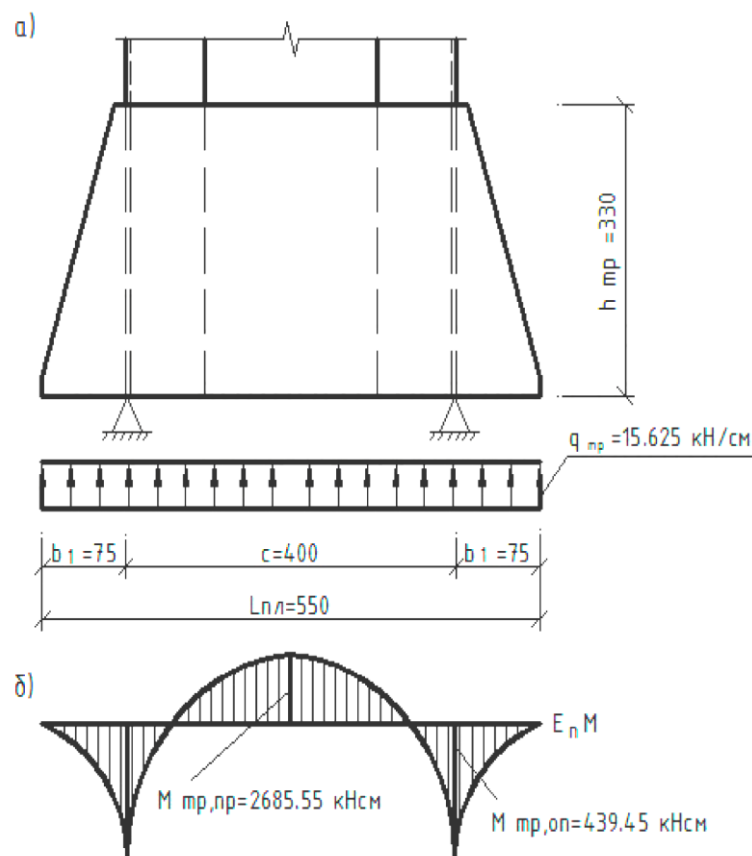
Розрахункова схема траверси для колони з двох швелерів
